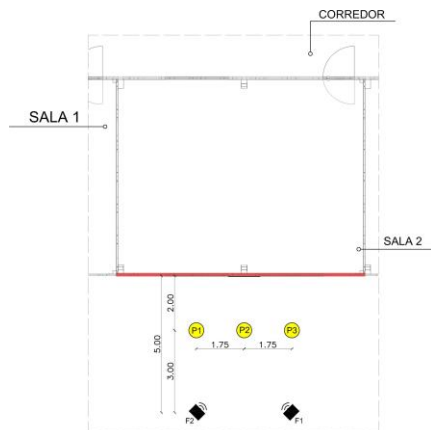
Situação 5 – Fachada (Emissão e Recepção)
